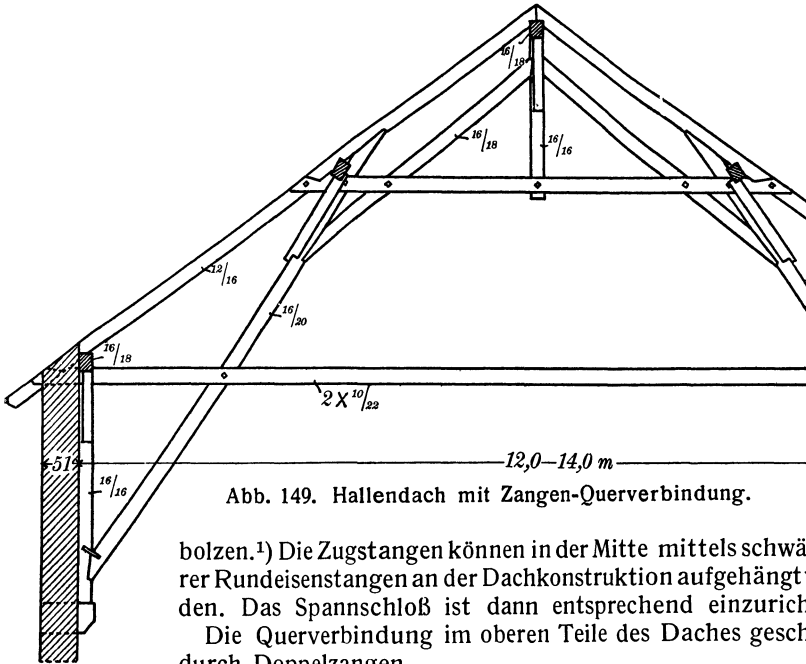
Hallendach mit Zangen-Quer Verbindung.
